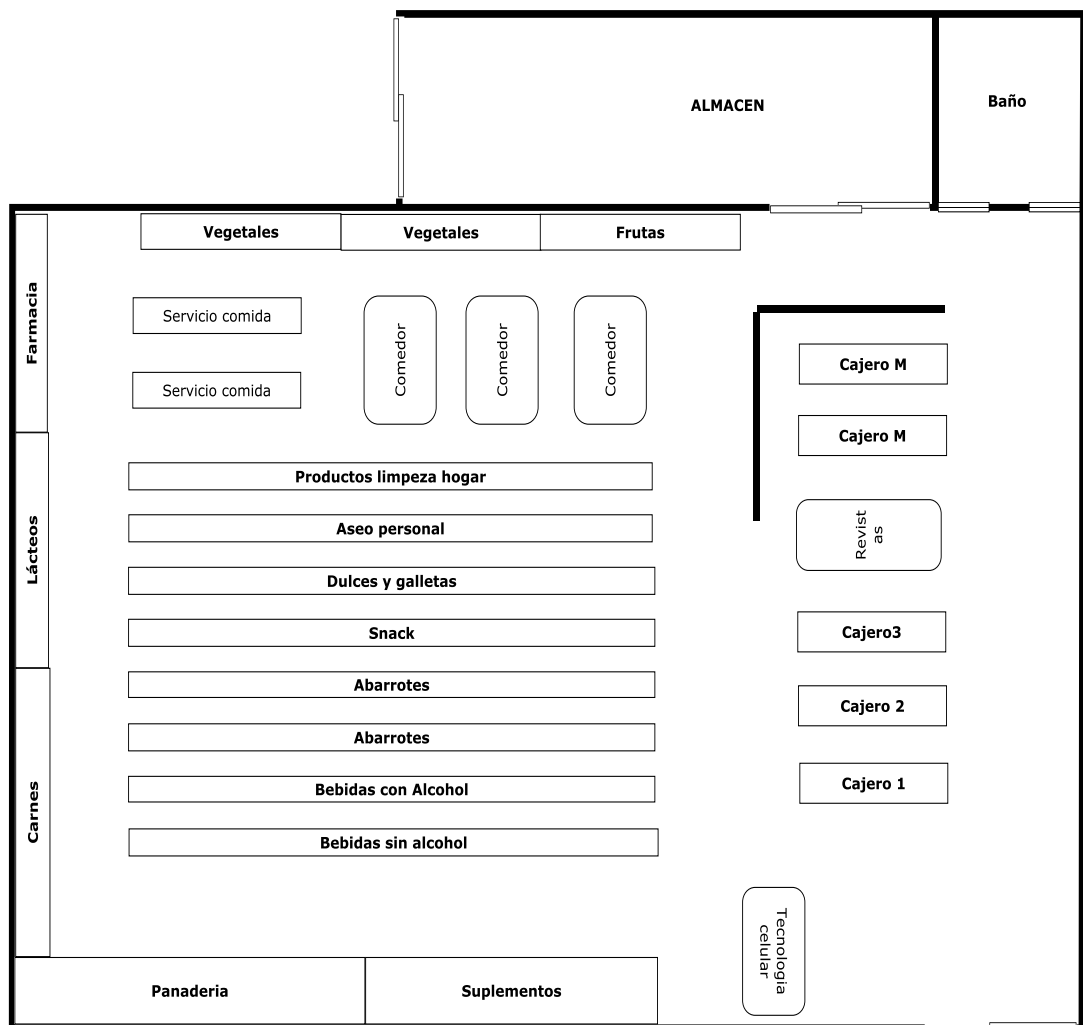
Plano de Planta tienda Vivanda de Benavides.
